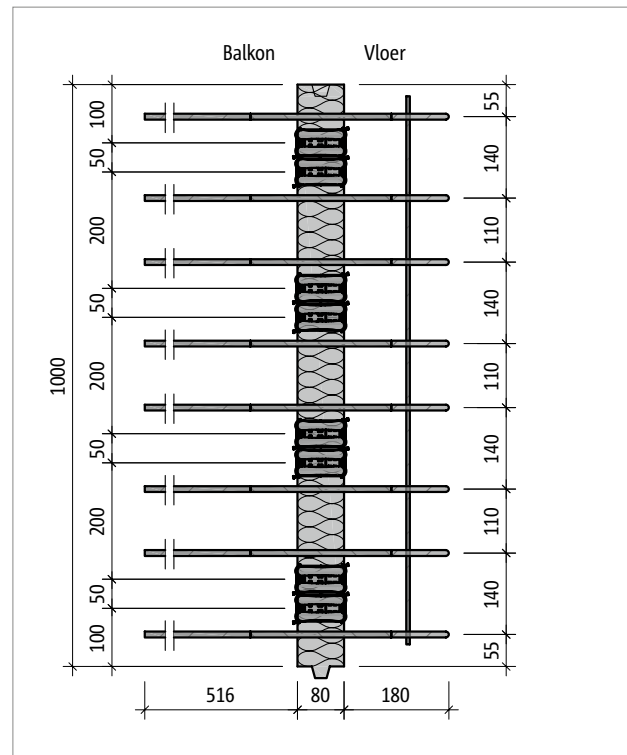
Schöck Isokorb® T type Q-E-V5: Zijaanzicht
